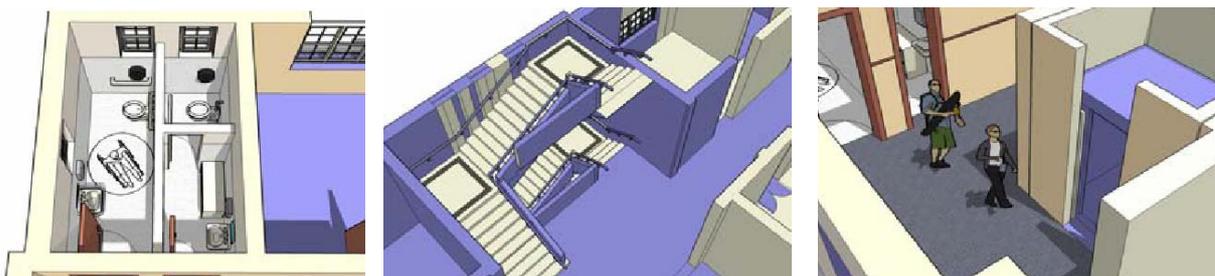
Proposta, abertura sob escada, ventilação e telefone acessível.
